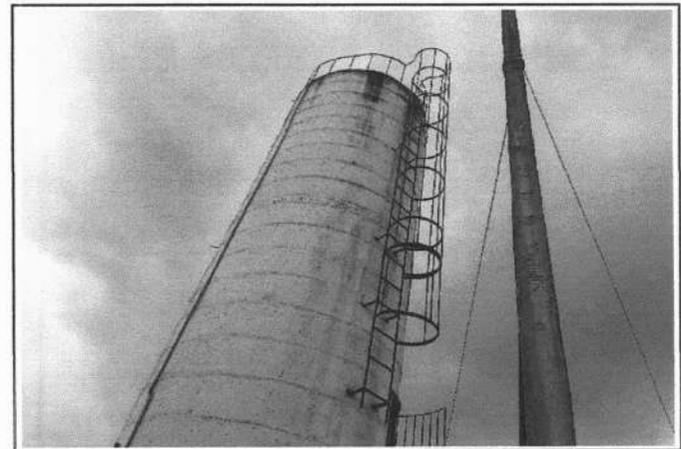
PINTURA E ESTRUTURAS DA CAIXA D'ÁGUA
